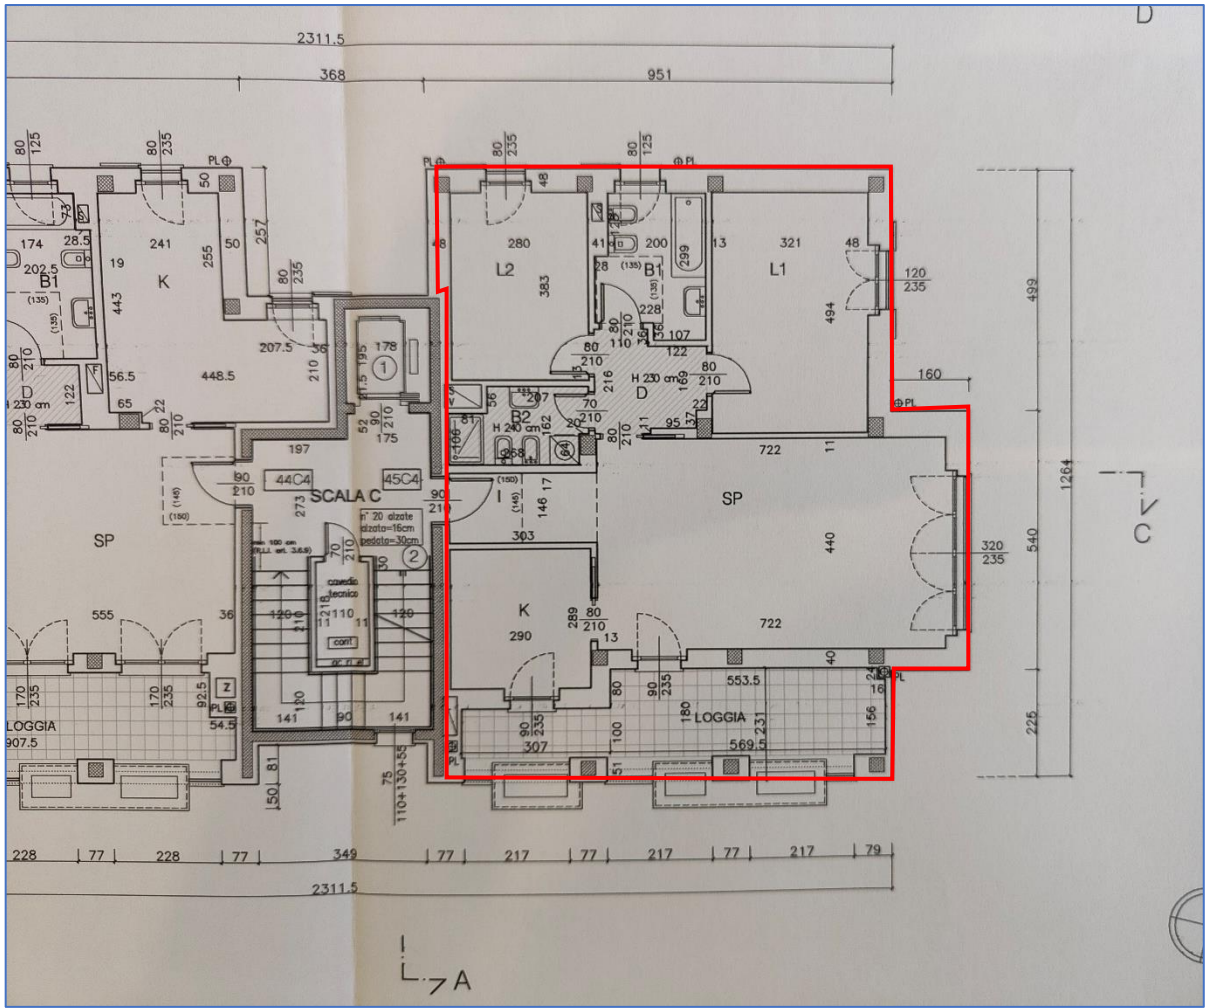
Estratto tavola di progetto Pratica 63/2013 - Appartamento
